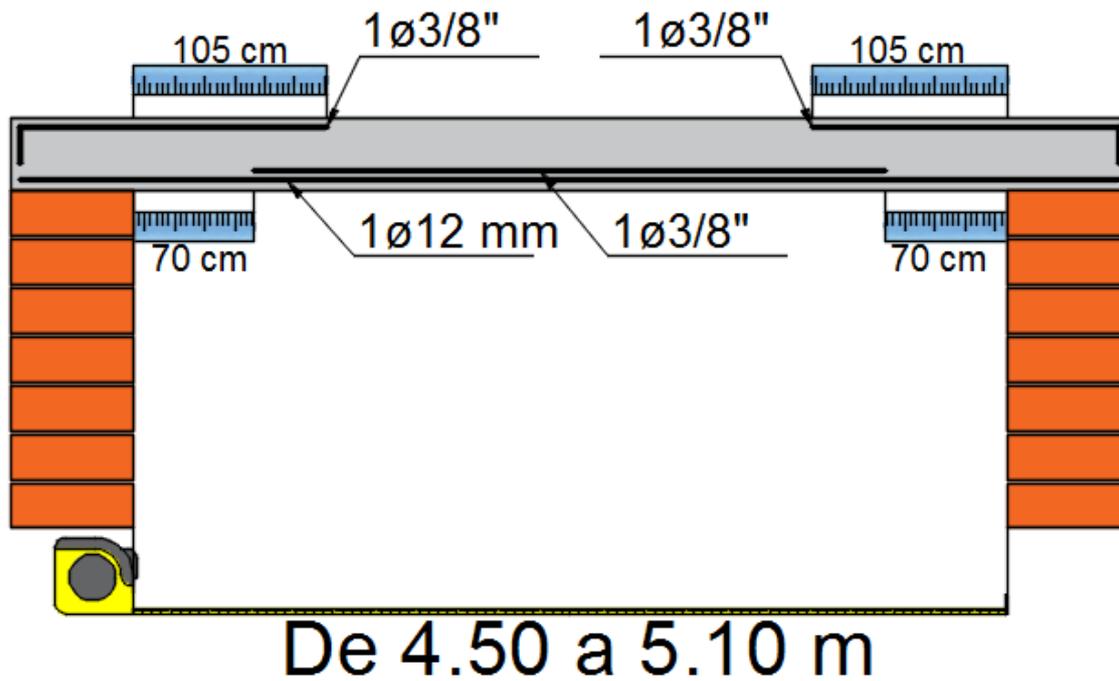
Refuerzo de vigueta hasta 5.10 m.
